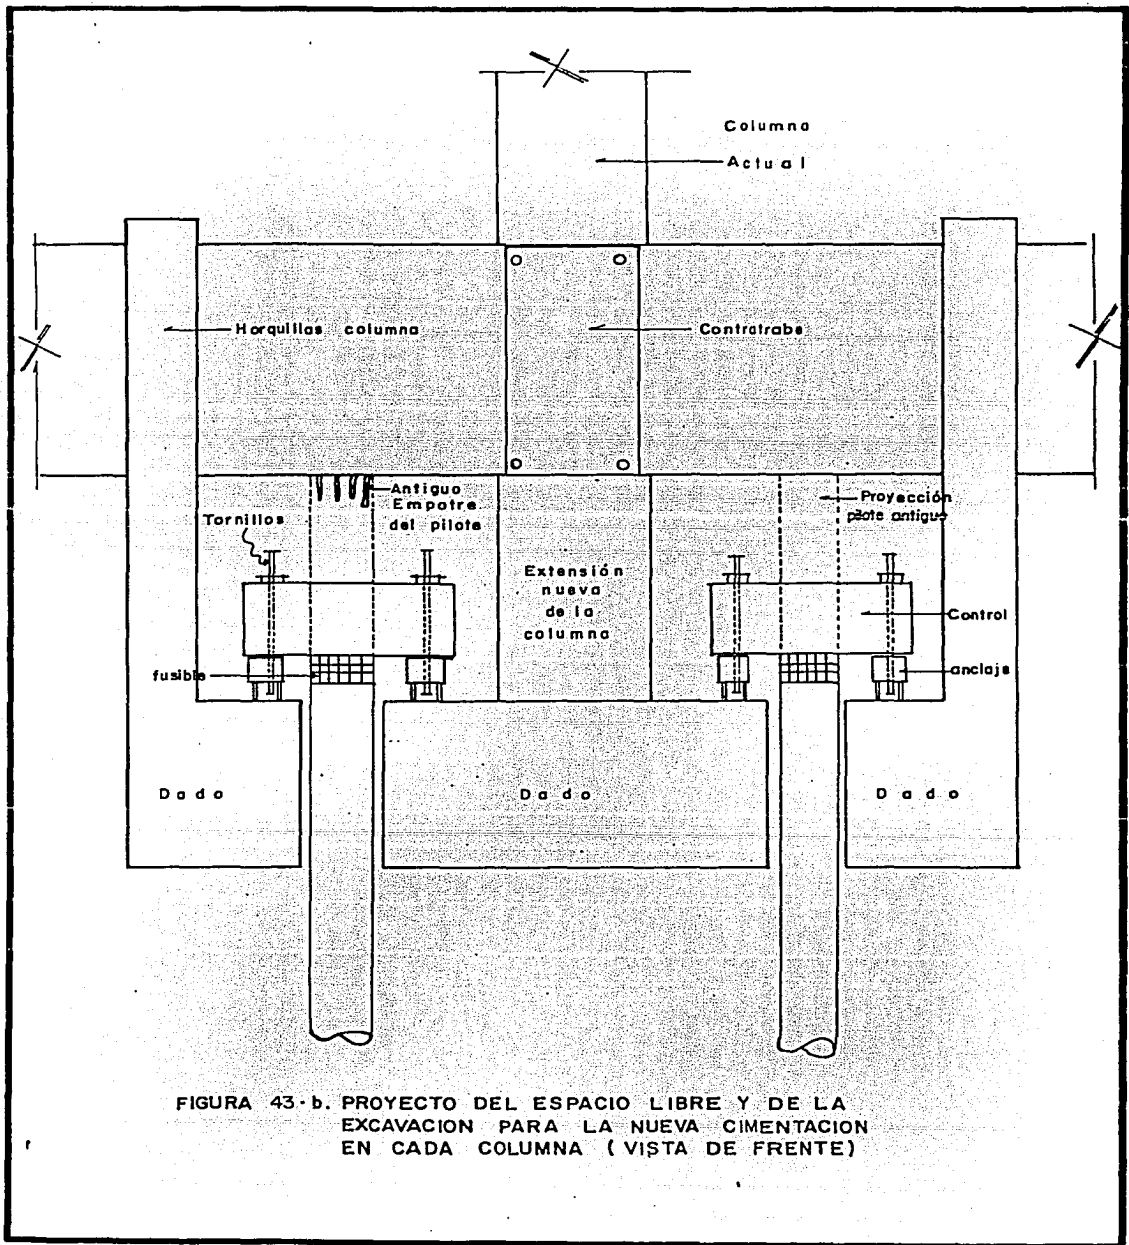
b. PROYECTO DEL ESPACIO LIBRE Y DE LA EXCAVACION PARA LA NUEVA CIMENTACION EN CADA COLUMNA (VISTA DE FRENTE)
